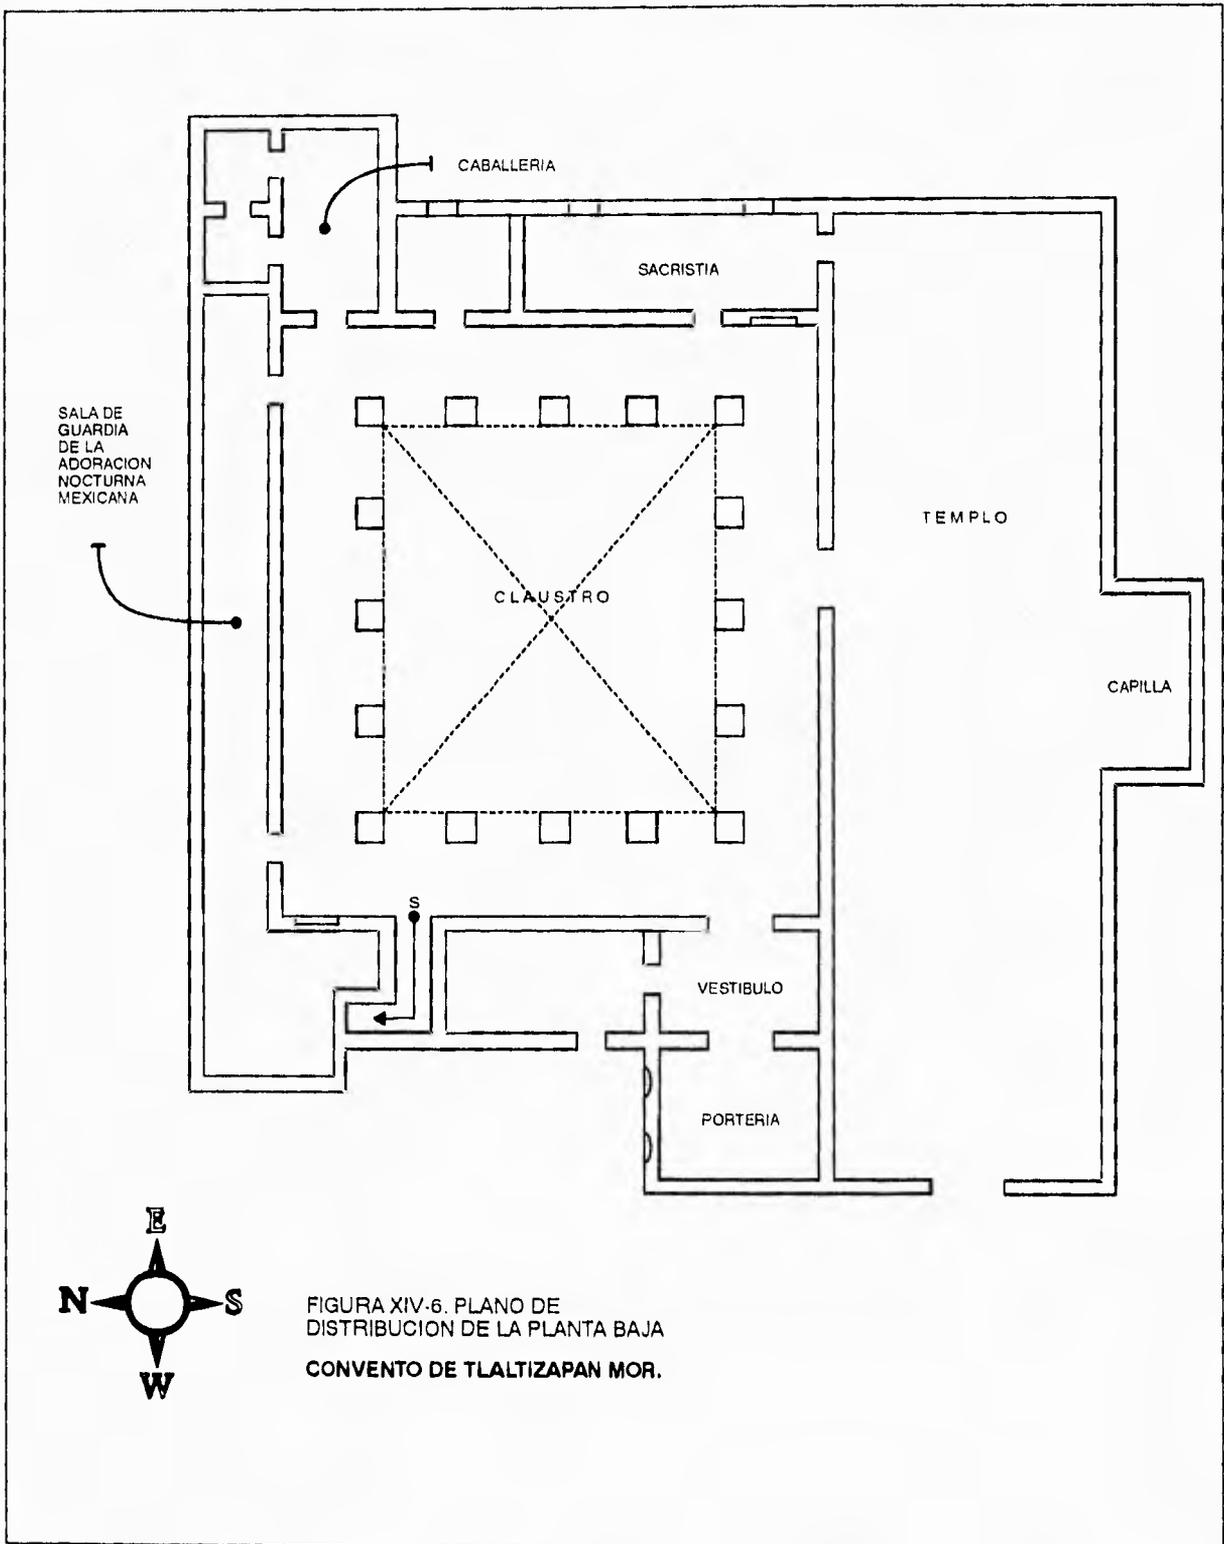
Plano de distribución de la planta baja del convento de Tlaltizapán.
